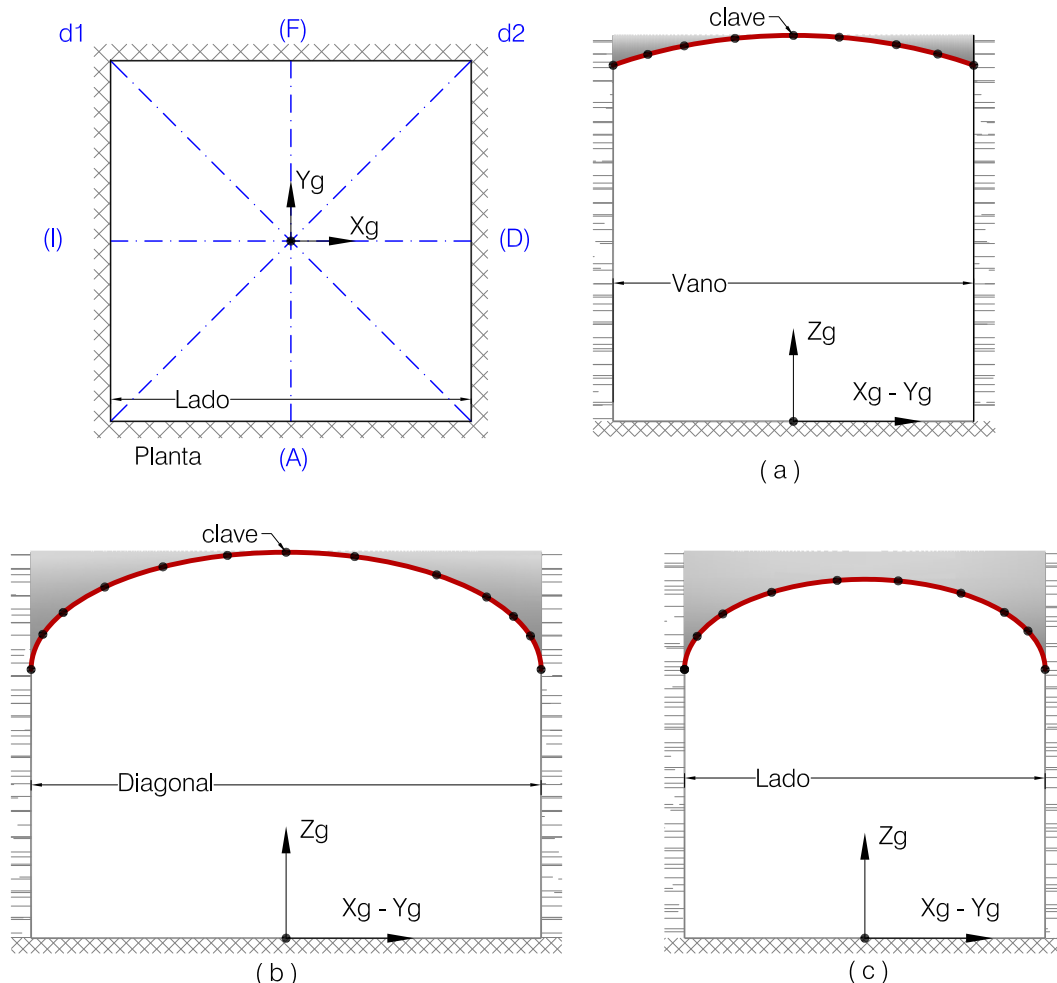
Puntos del levantamiento topográfico y situación del sistema general de referencia en planta. Secciones (a) entre muros opuestos: FA, ID; (b) en aristas diagonales: d1, d2; (c) en aristas en los muros: F, A, I, D.
